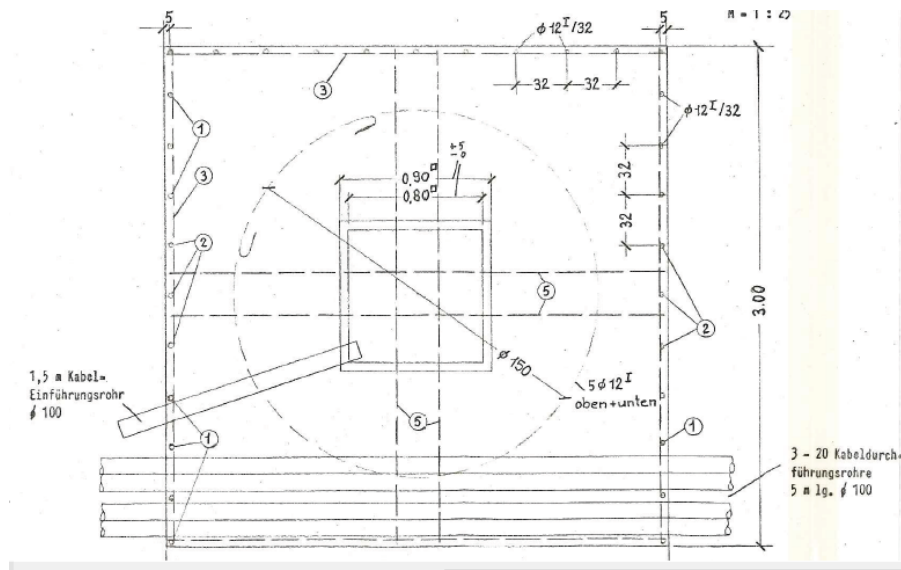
Konstruktionszeichnung Beton-LHM-Fundament, Draufsicht; Quelle: HEW-Zeichnung 6516/2 v. 20.7.73
